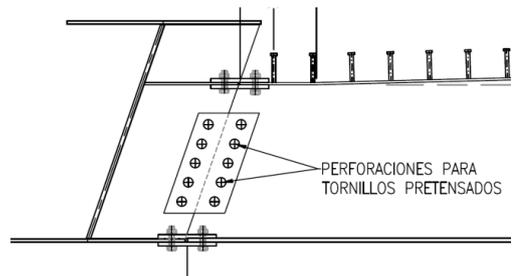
Detalle de la unión de la viga transversal a la viga longitudinal en los puentes de 75m y de 85m
